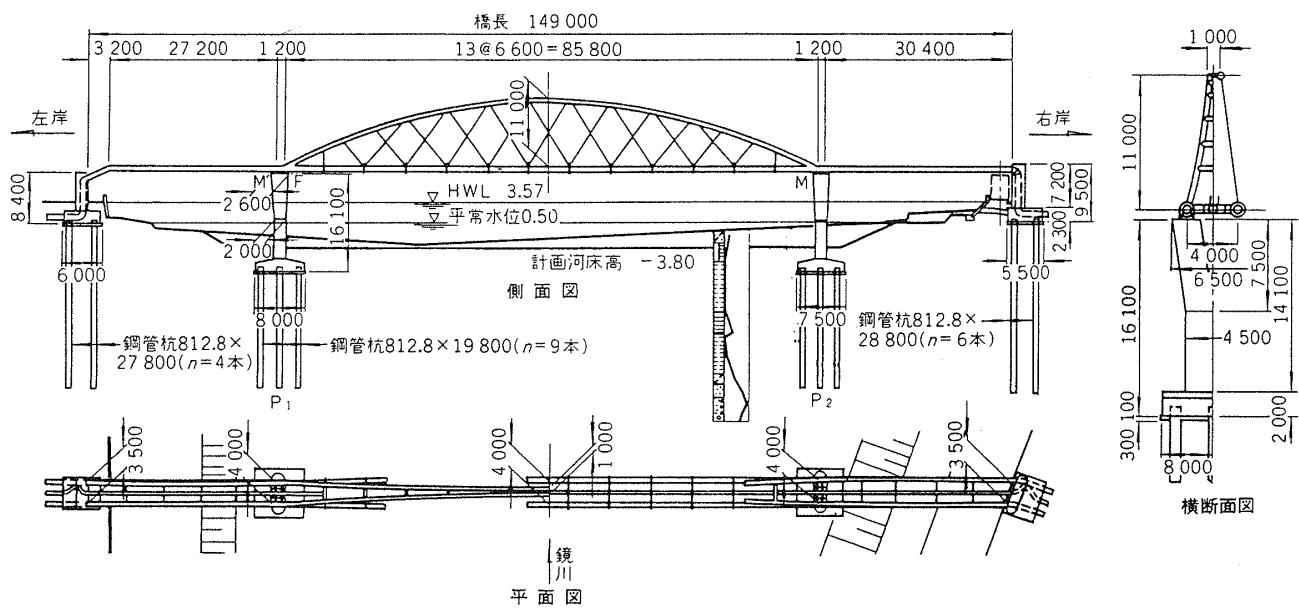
鏡川水道橋（高知市）⁷⁷⁾
